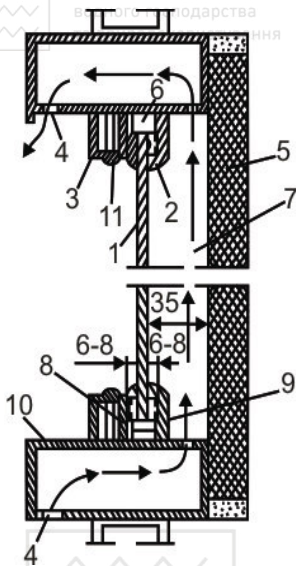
Кріплення стемаліту при облицюванні фасаду будівлі:
